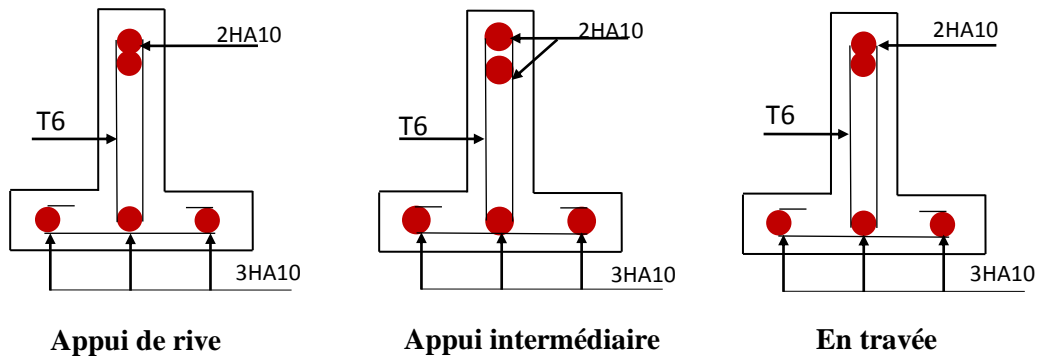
Ferrailage des poutrelles (Type 04) .
